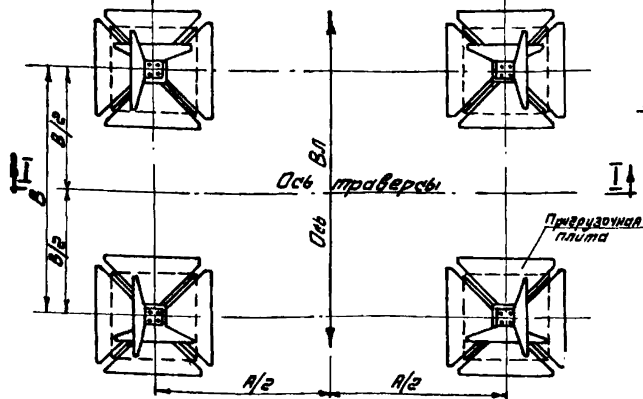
Схема расположения фундаментов под анкерно-угловые опоры У1У2, У2+5, У1+12, У2+12
